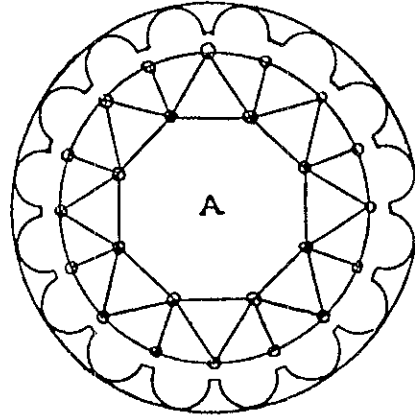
Leonardo da Vinci: Planta de Santa Maria in Praticchia, Pavia.
